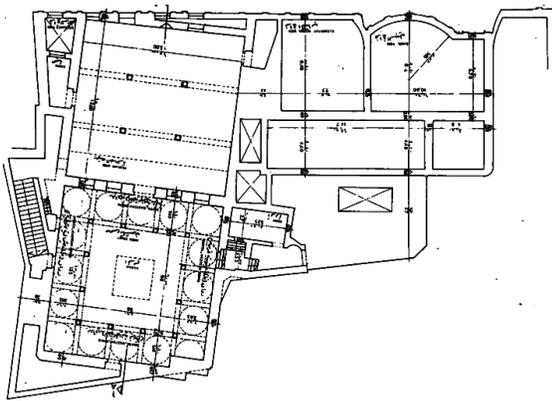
المسقط الأفقي لجامع داعي الدار بفوة
